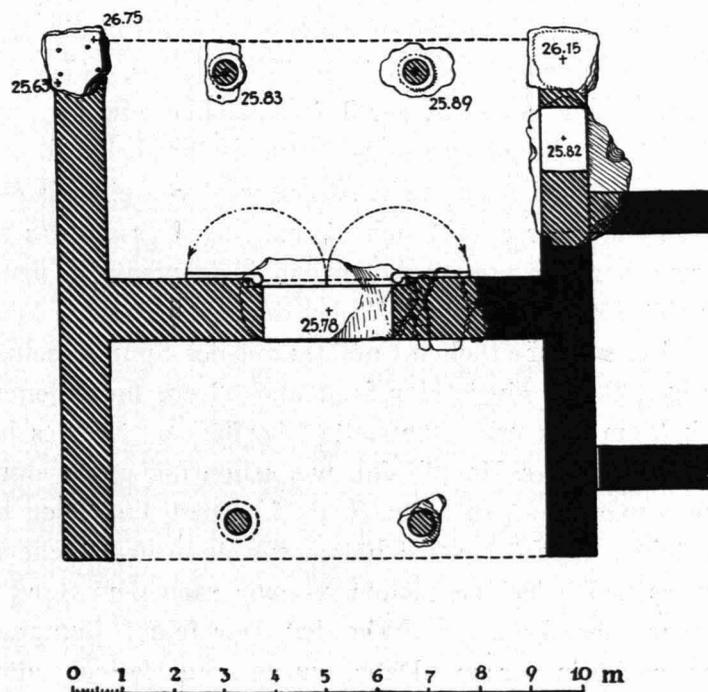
Das kleine Propylon. Ergänzter Plan.
